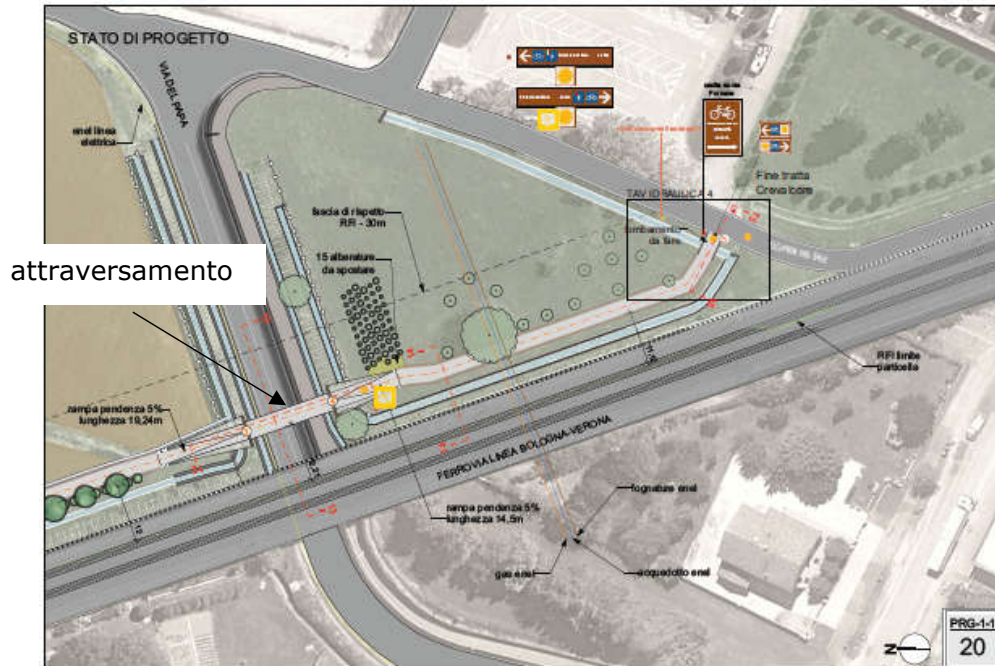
Attraversamento della strada SP9 - stralcio planimetrico
